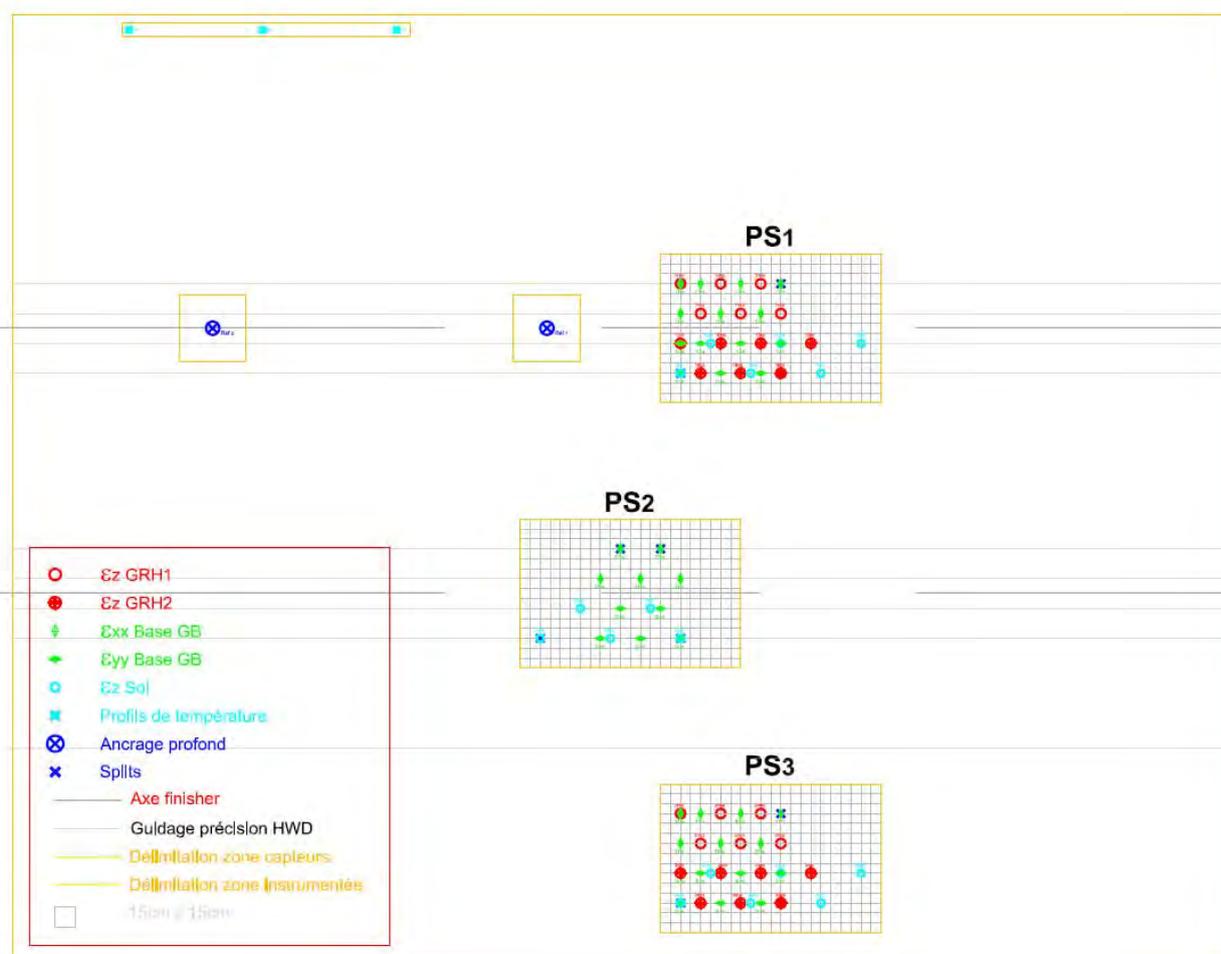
Organisation générale de l'instrumentation de la chaussée souple
